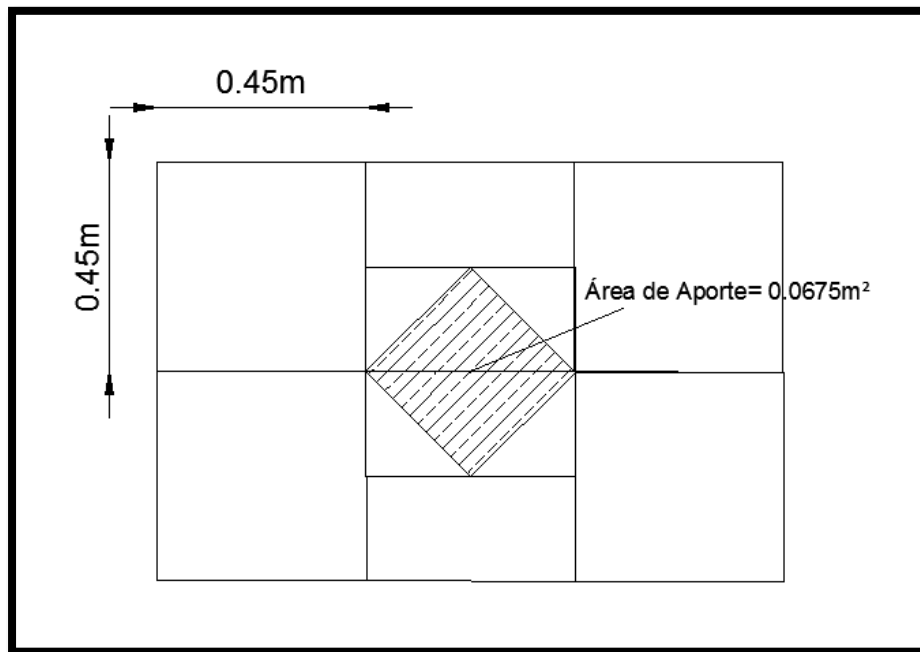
Vista en Planta de la Pirámide de Base Cuadrada
